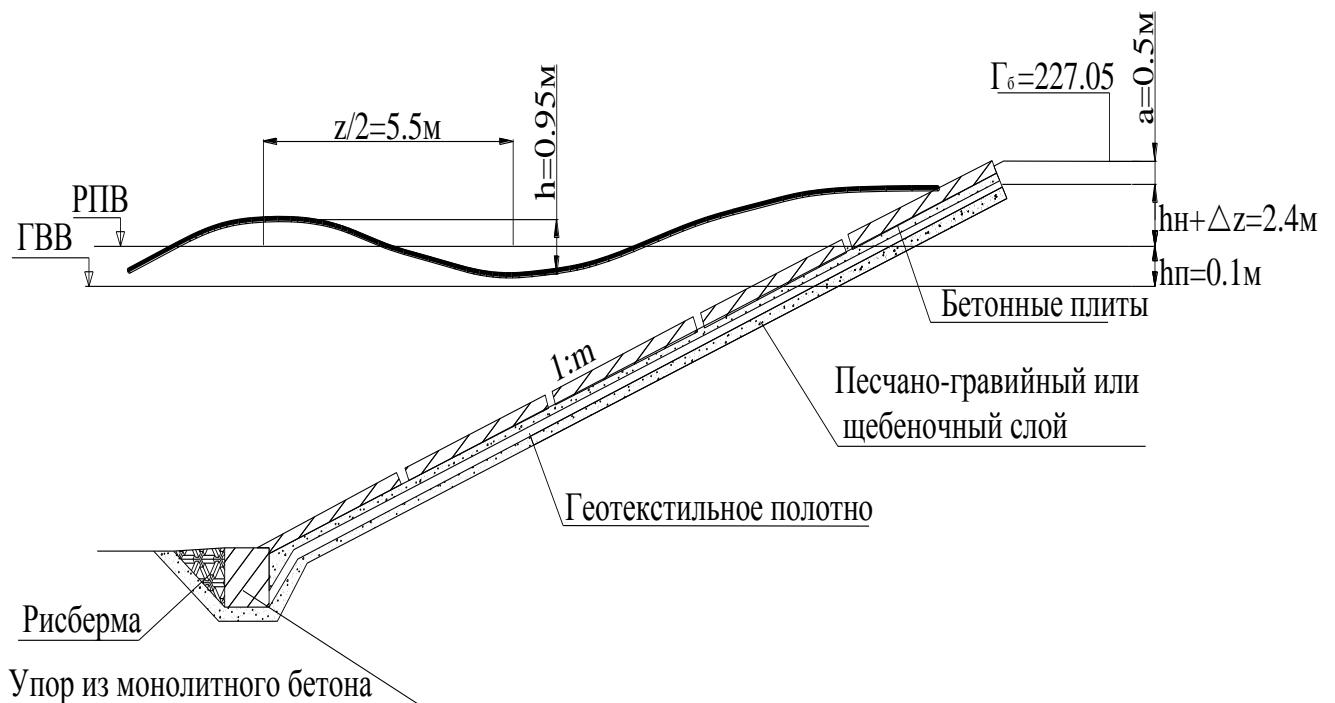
Конструкция укрепления откоса бермы бетонными плитами на щебеночной подготовке с геотекстильной подложкой
